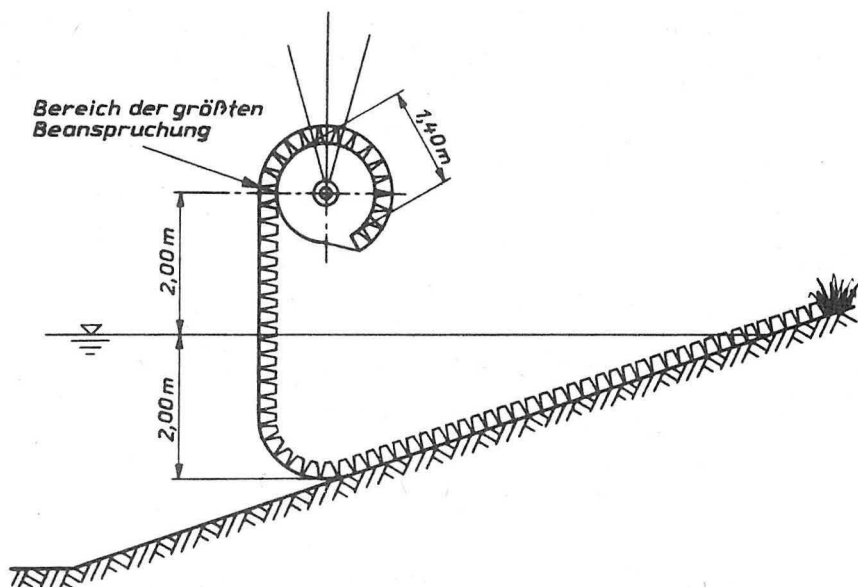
Prinzipdarstellung des Einbauvorganges einer Betonsteinmatte
